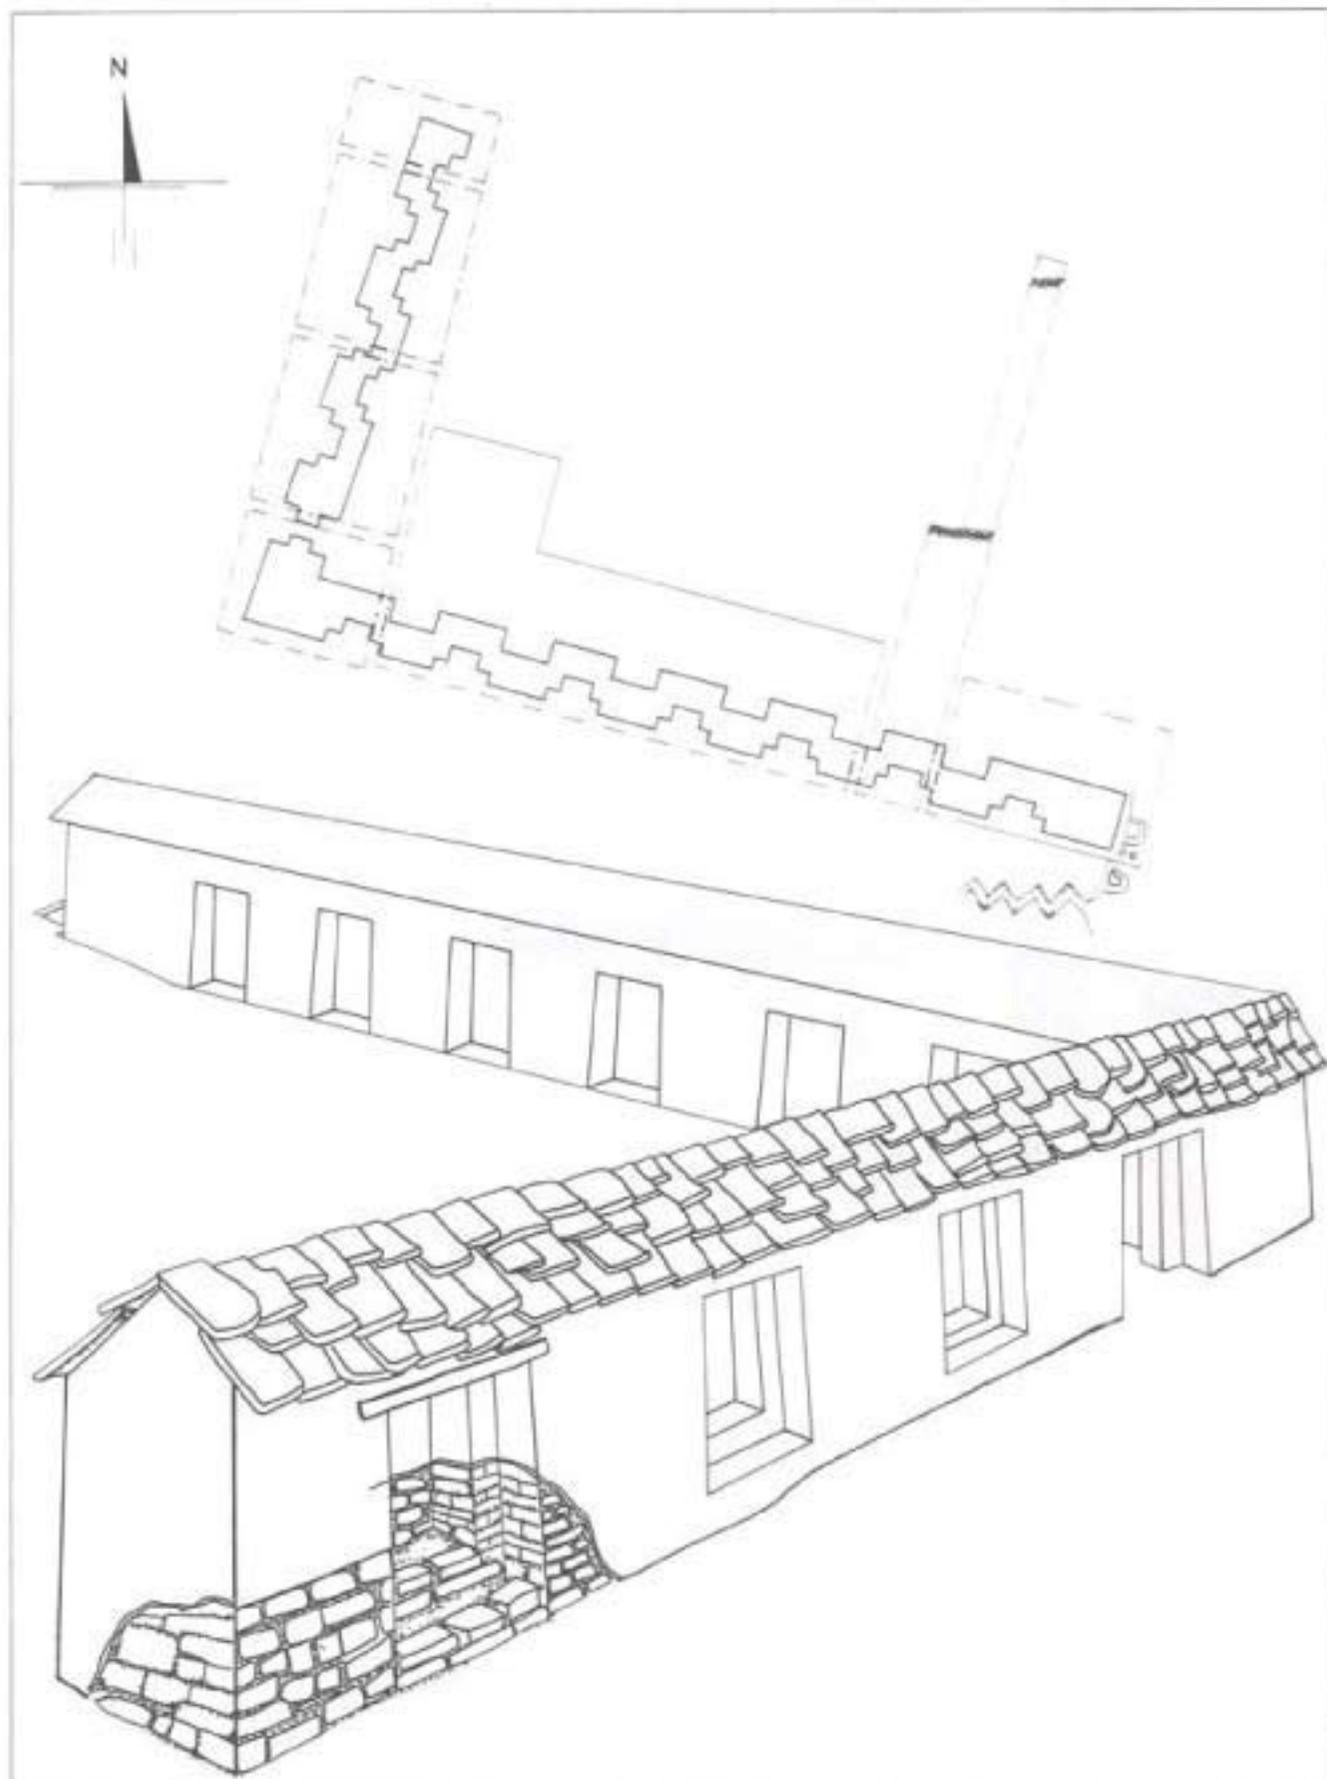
b. Sector 9, galería de nichos, plano y reconstrucción (diseño: Javier Gonzáles).
